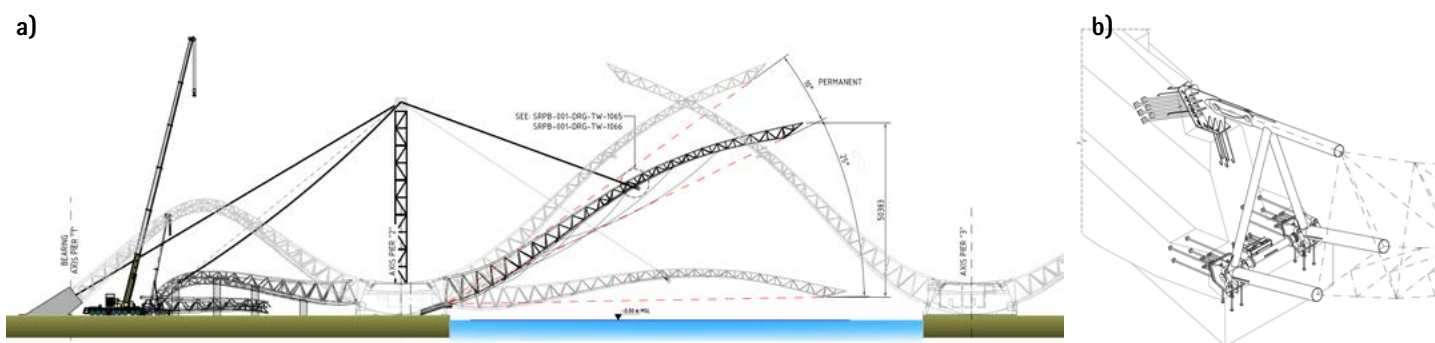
Schema di sollevamento degli archi in acciaio; b) Modello 3D della connessione alla base degli archi con le pile
